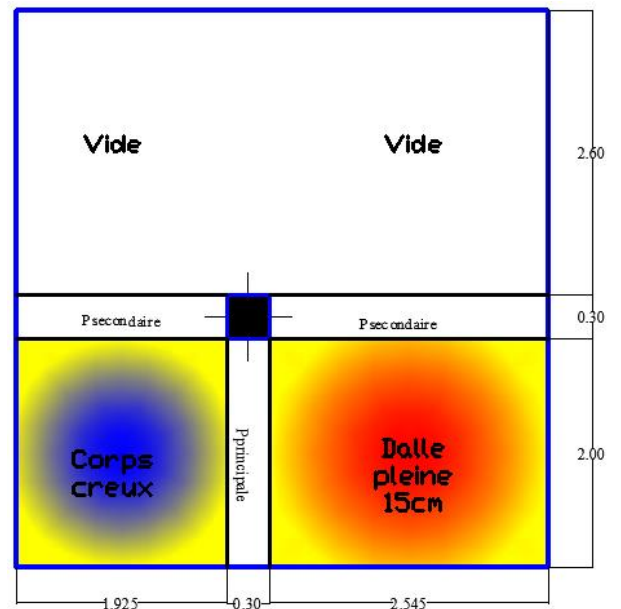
Surface du poteau (P1) de la salle de machine
